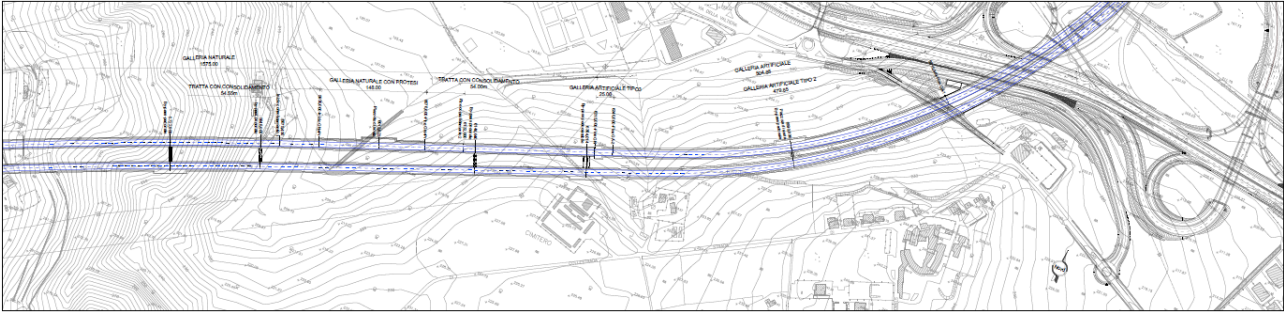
Stralcio planimetrico della galleria con vista su imbocco nord
